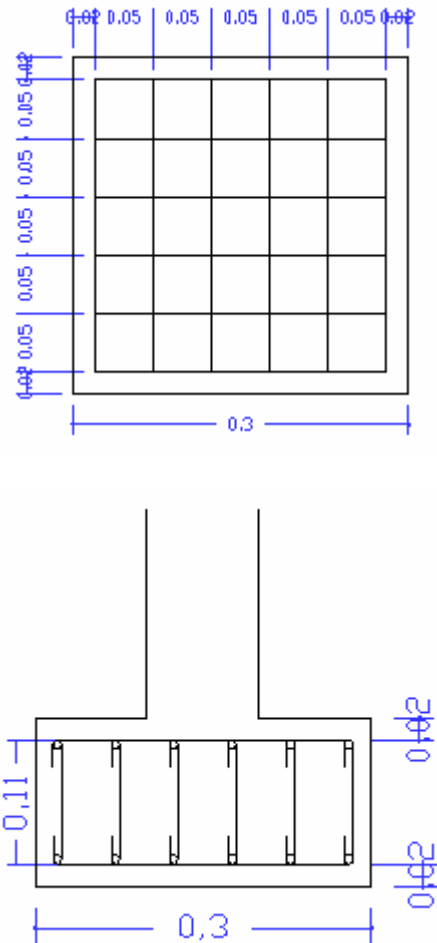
Disposición de las varillas de refuerzo del soporte del espécimen
